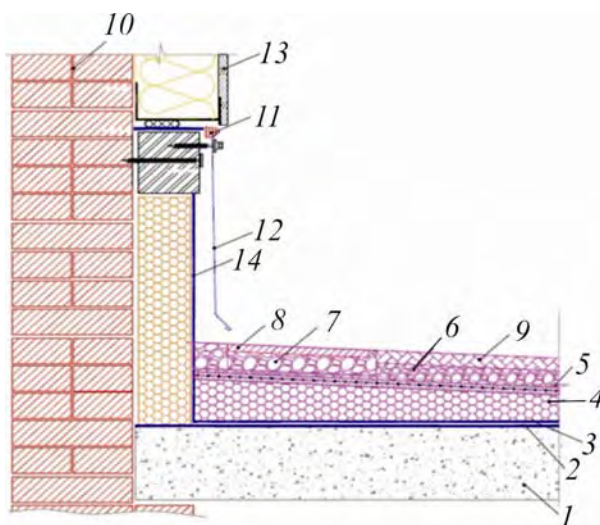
Зона примыкания инверсионной крыши к наружной стене: 1 — железобетонная плита перекрытия; 2 — грунтовочный слой; 3 — гидроизоляционный ковер из рулонных материалов; 4 — экструдированный пенополистирол; 5 — фильтрующий материал; 6 — дренирующий слой гравия диаметром 4...8 мм, дренирующий слой гравия диаметром 16...32 мм; 8 — тротуарная плитка; 9 — слой почвы (не обязателен); 10 — наружная стена; 11 — нетвердеющий герметик; 12 — металлический фартук; 13 — наружная обшивка стены; 14 — дополнительный слой гидроизоляционного материала
